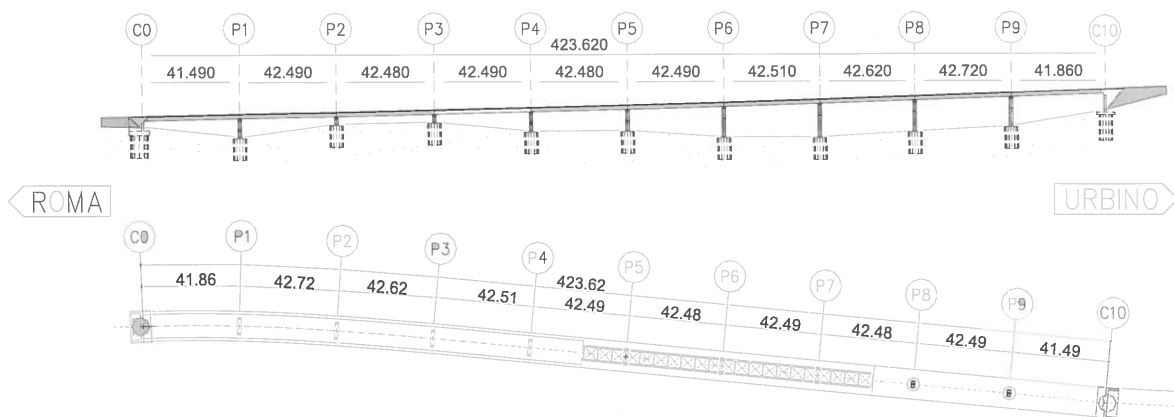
Viaduc Ca' Raniero 2 : Élévation et vue en plan / Elevation and plan view
